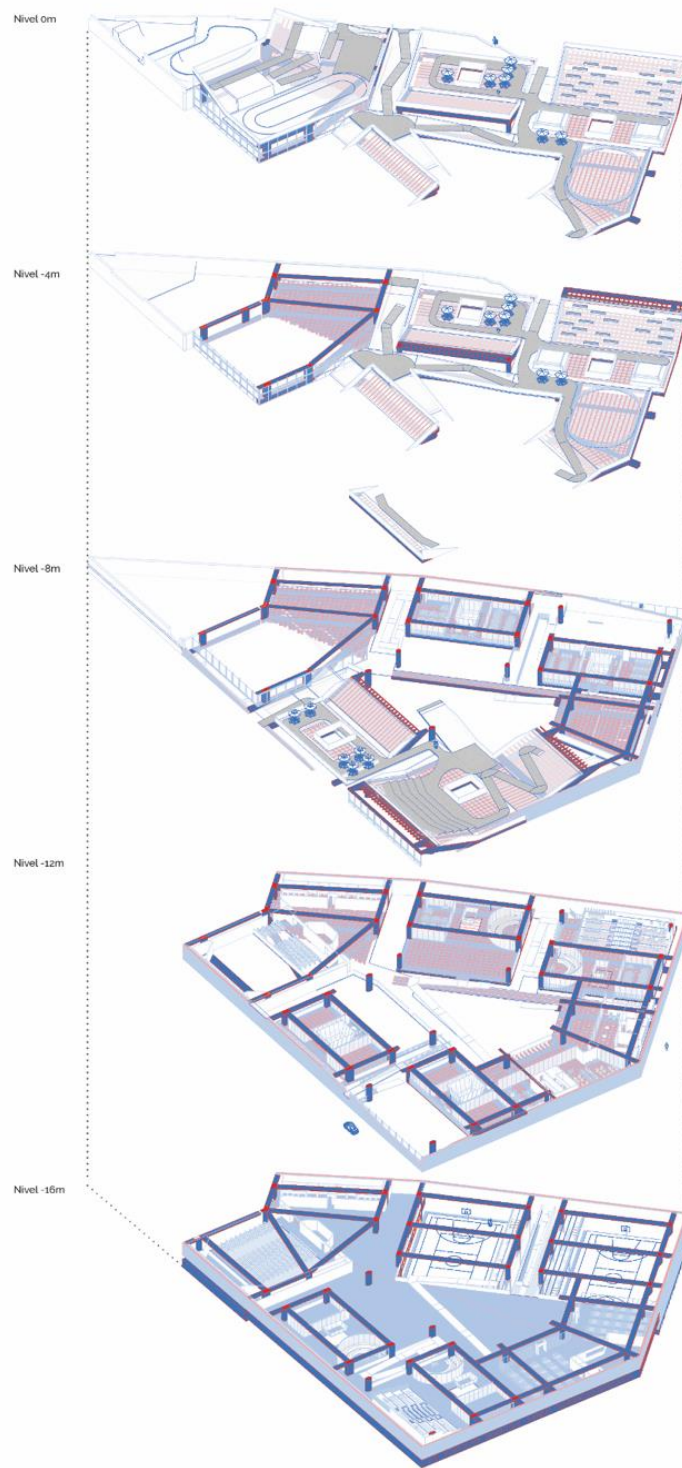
Sistema estructural. Fuente: Elaboración propia.
